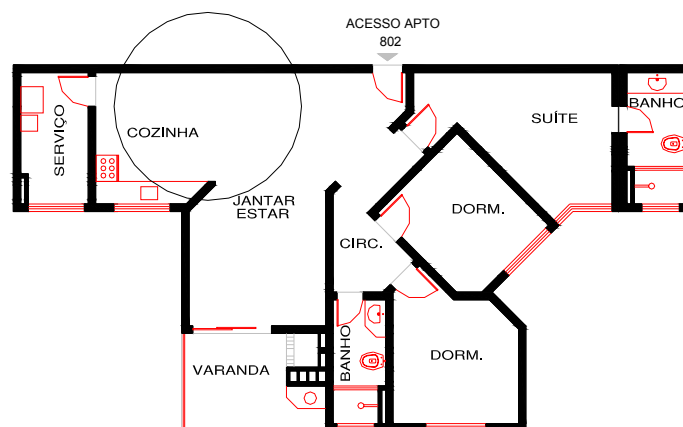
Planta Baixa do apartamento 802 – Estudo de caso A.
